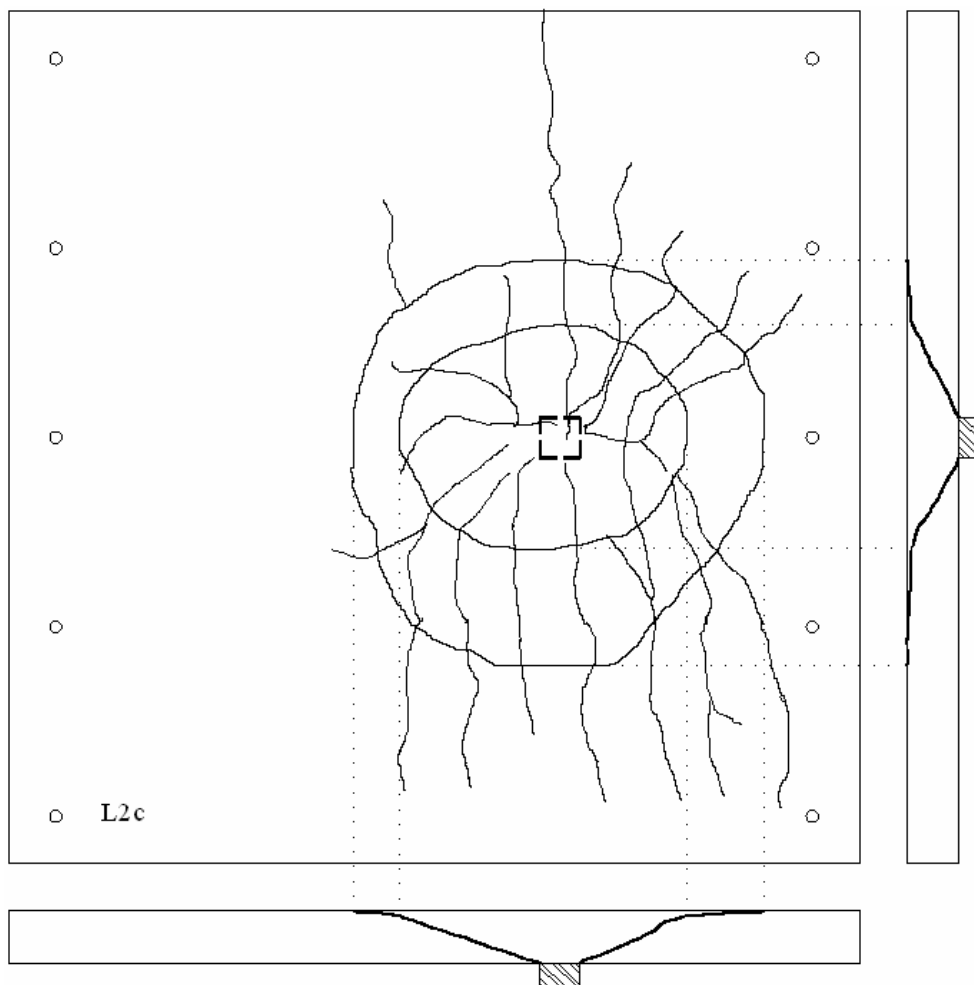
Mapa de fissuração da laje L2c
